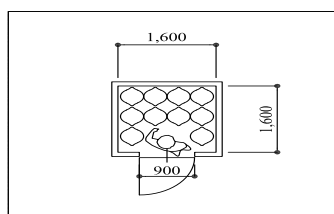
Plan de masse de l'entrepôt de glace (par chaque section)
